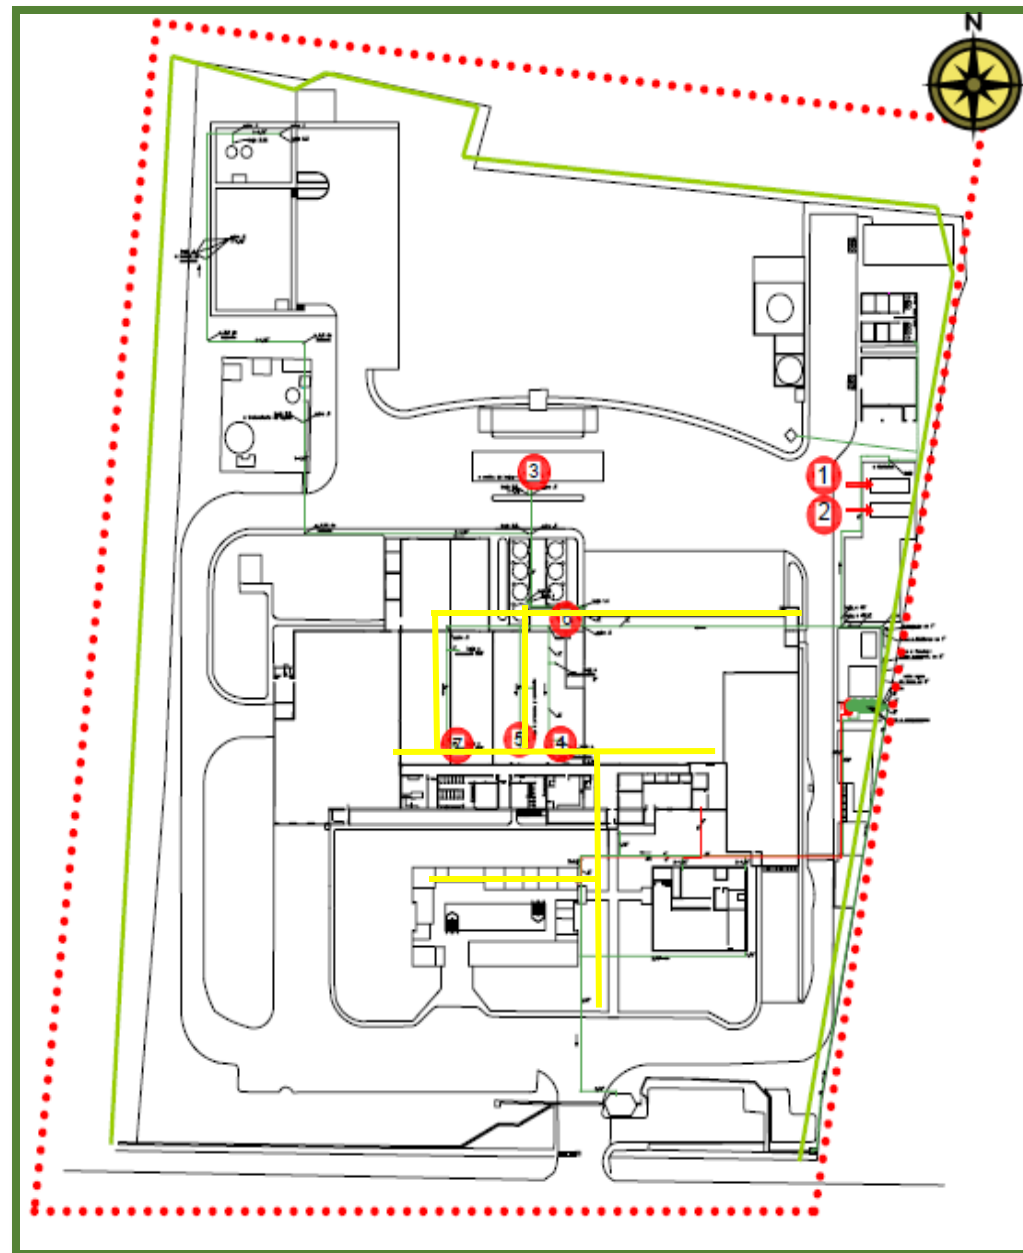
Plano Arquitectónico General de planta de procesamiento.
